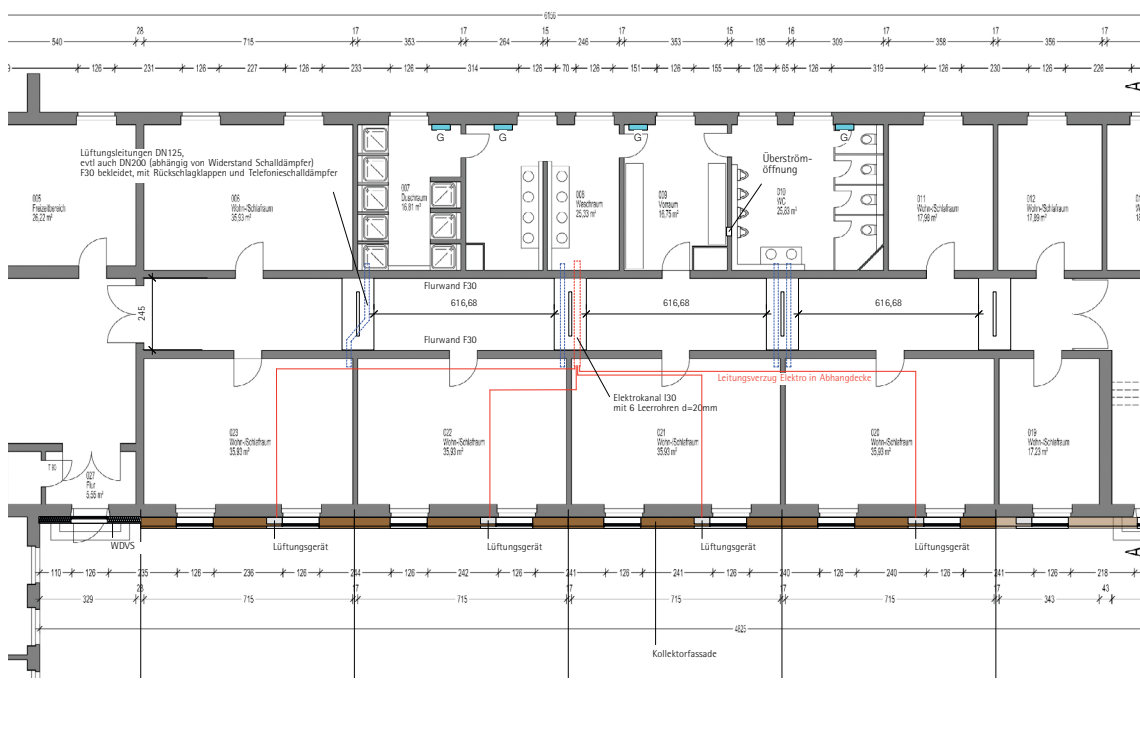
Grundriss mit Kollektorfassade und Überströmkanälen
